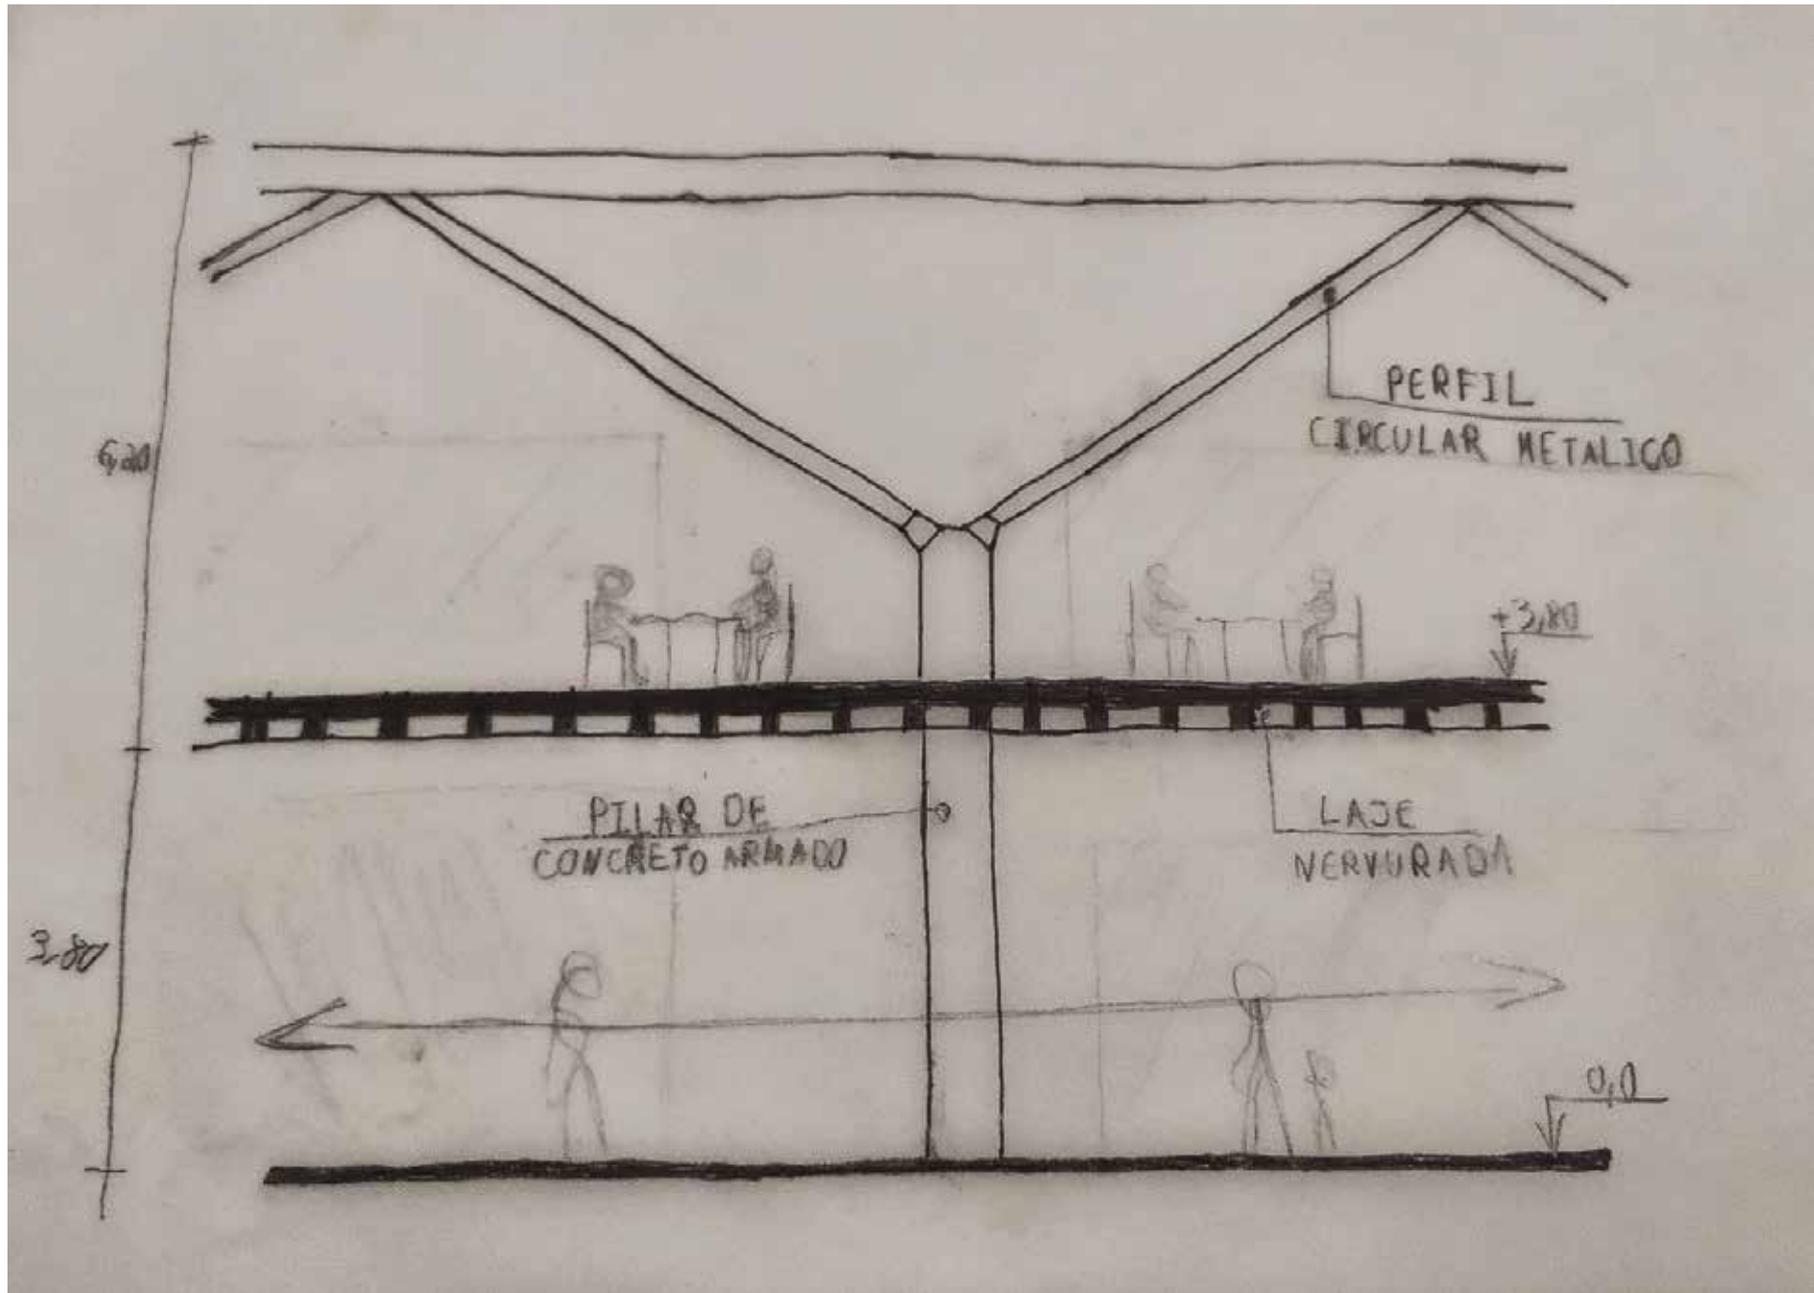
Croqui com a relação de alturas do módulo estrutural.
